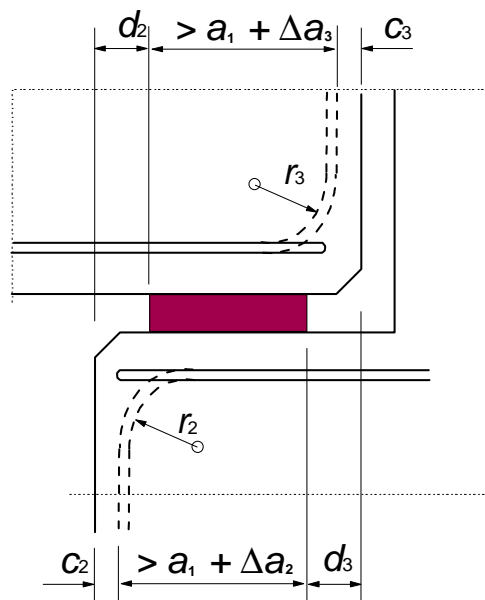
Exemplo de uma disposição construtiva da armadura no apoio
